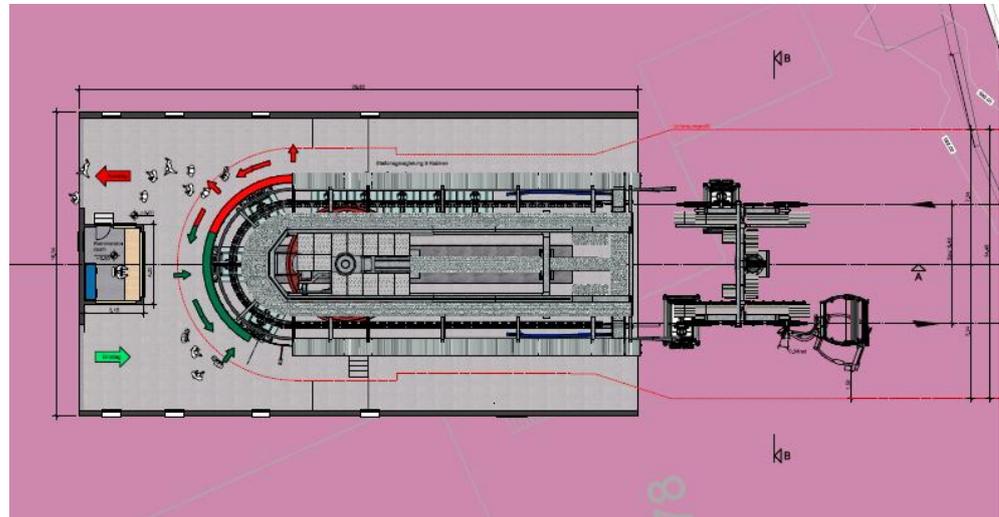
Grundriss Talstation Chur einer Umlaufbahn
